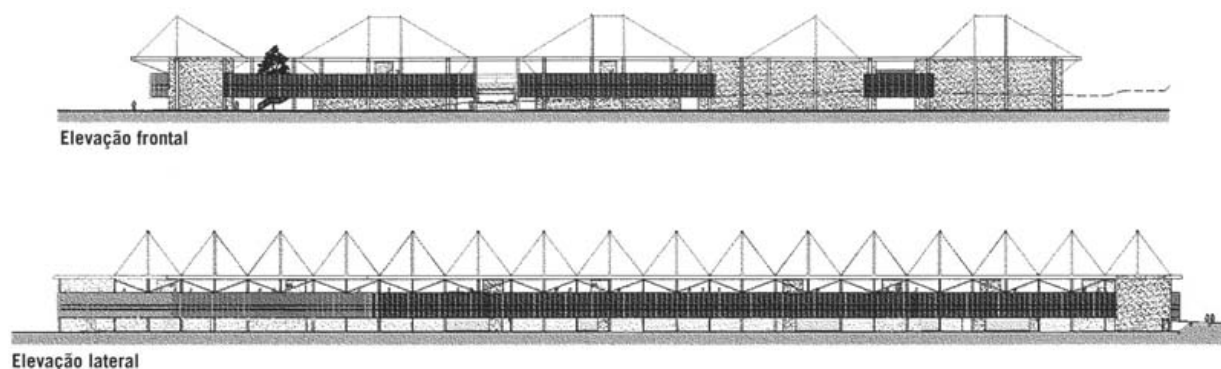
Elevações frontal e lateral do conjunto (Fonte: Marcelo Suzuki)
